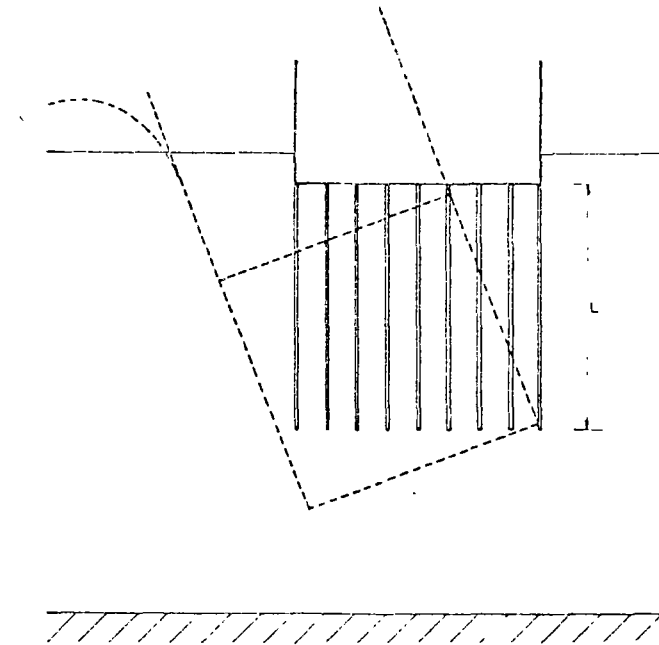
Falla de conjunto de una cimentación con pilotes de fricción
